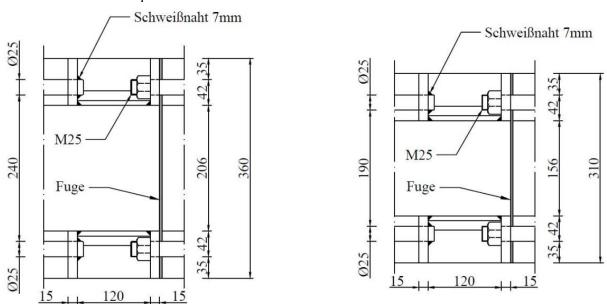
Horizontalschnitt (links) und Längsschnitt (rechts) des Anschlussdetails
